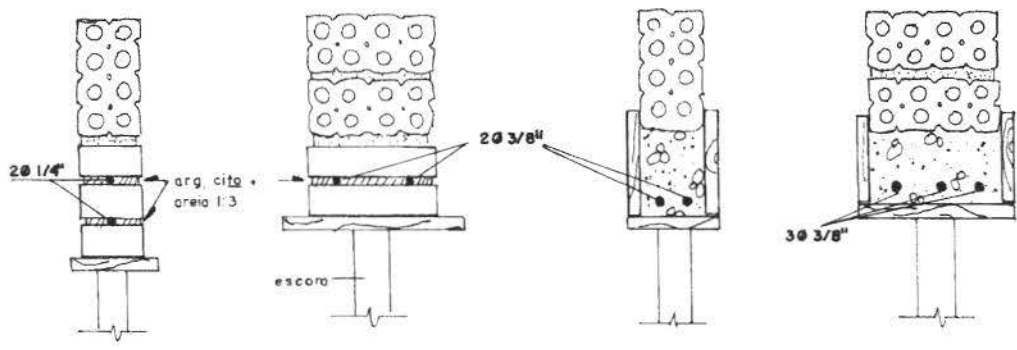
Vergas em alvenaria de tijolo furado para vãos até 1,00m e entre 1,00m e 2,00m.
